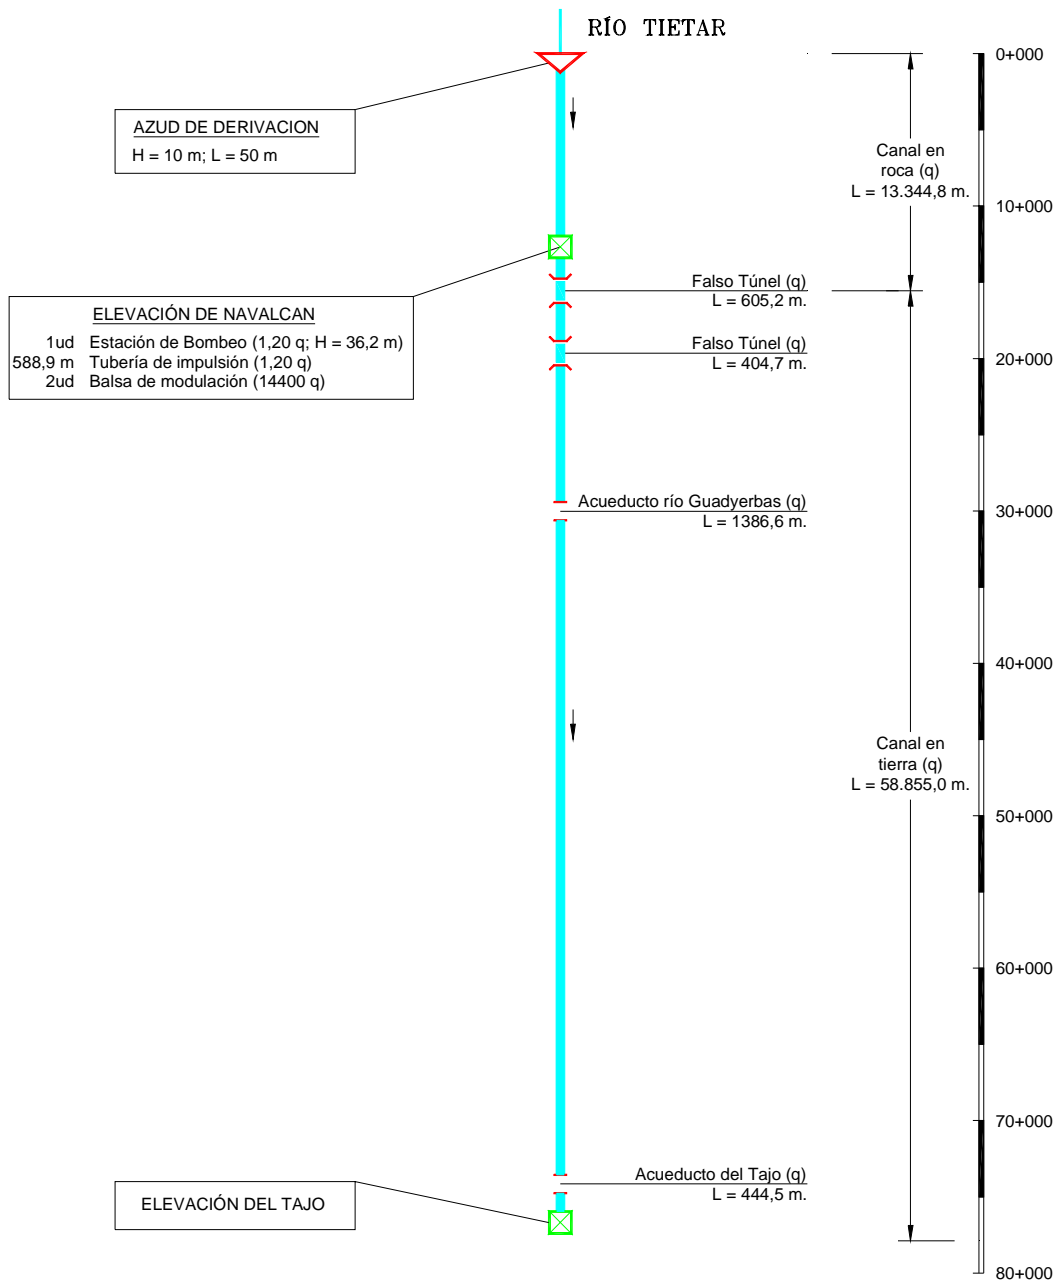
Conducción Tiétar-Aldeanueva. Esquema en planta
